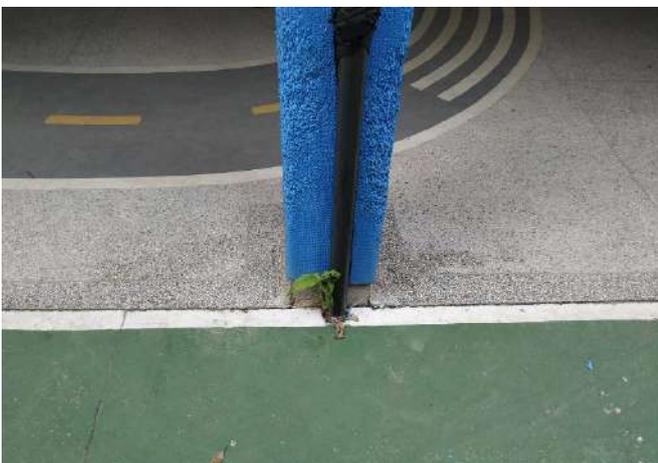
Tubo de proteção. Falta caixa de inspeção.
